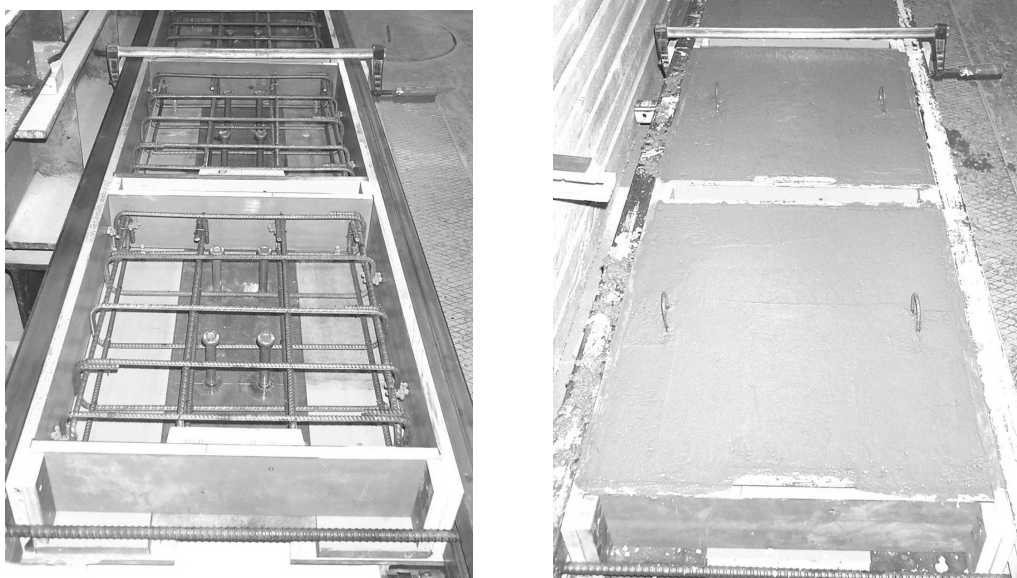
In die Schalung eingebaute Stahlgurte mit Kopfbolzen und Bewehrung (links) und betonierte Gurte (rechts)
